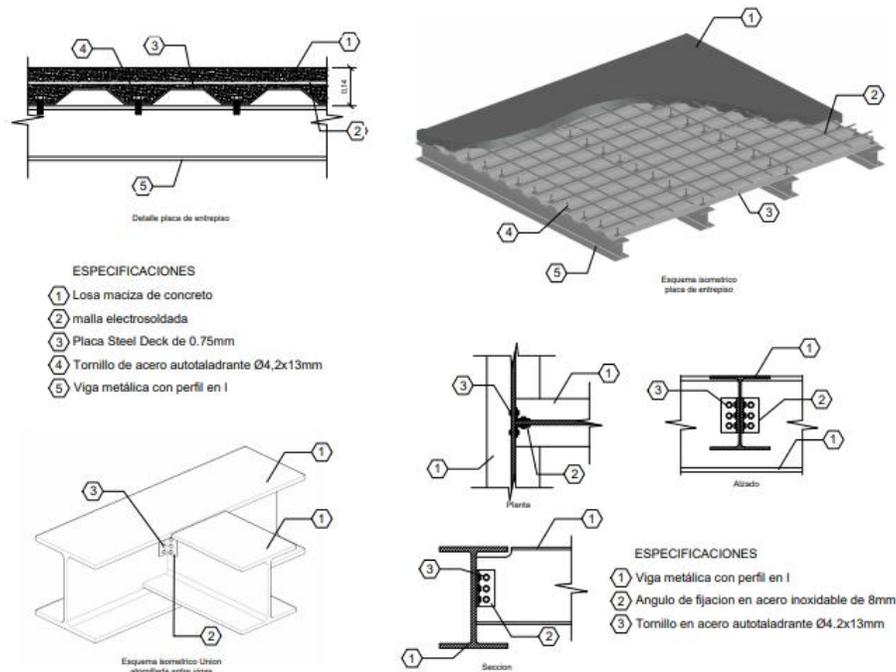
Detalle constructivo placa de entrepiso. Elaboración propia.
